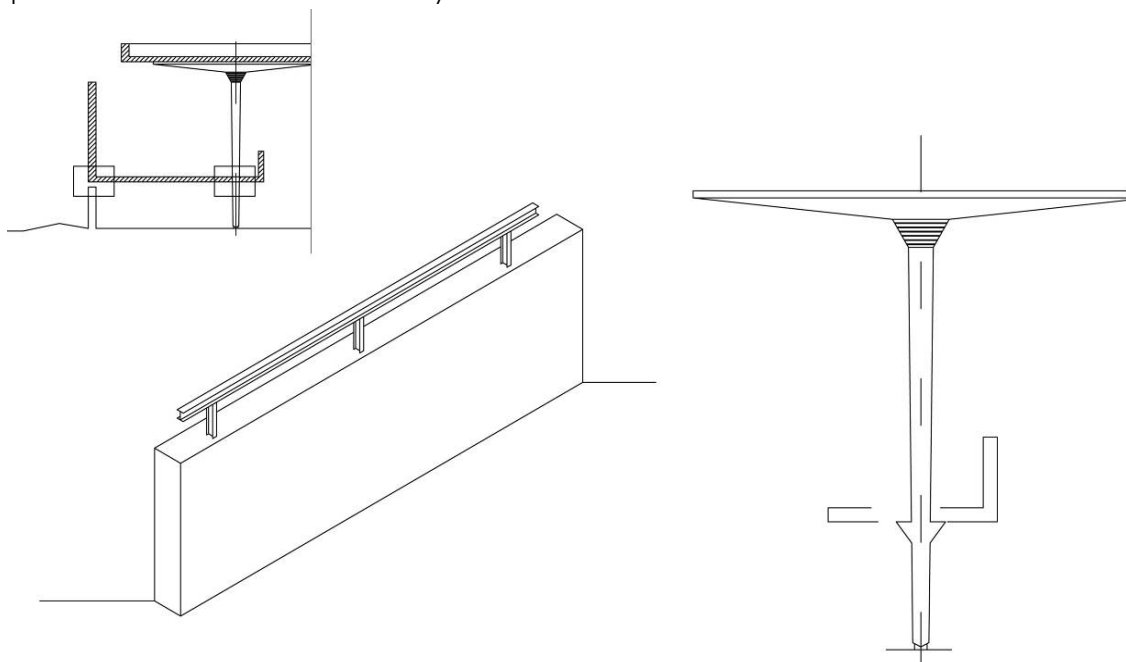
Esquemas de las soluciones realizadas por Wright en cuanto al forjado de la planta intermedia.
